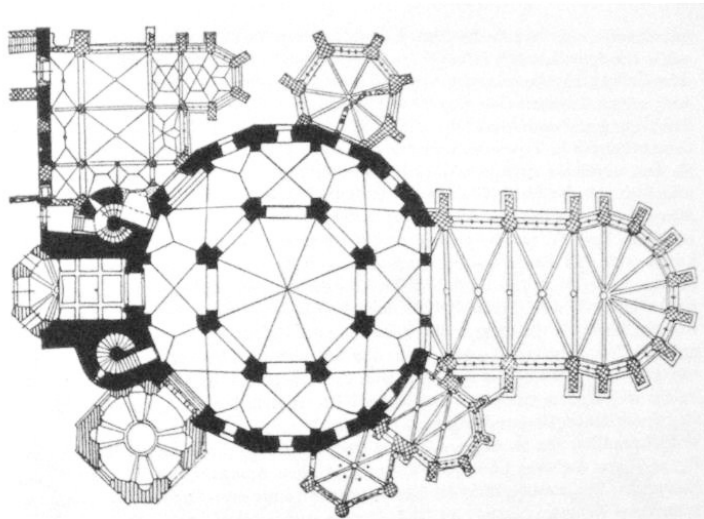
Grundriss, St. Marien, Aachen, um 800.
